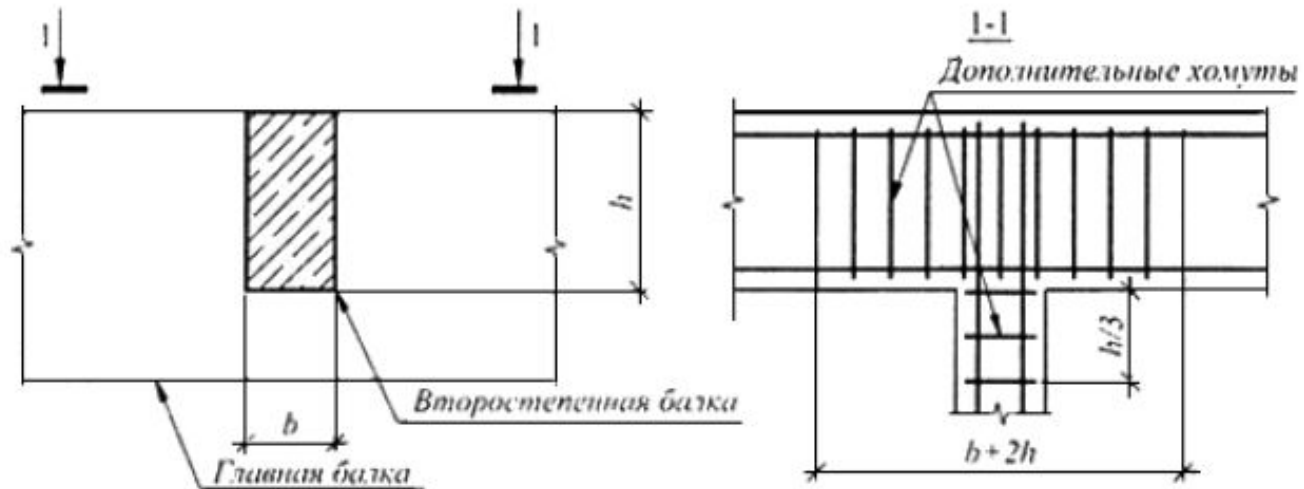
Размещение опорной арматуры в зоне пересечения двух балок
